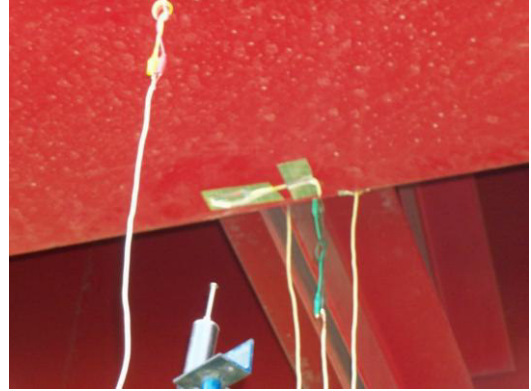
Fijación de deformímetro y colocación de LVDT.
